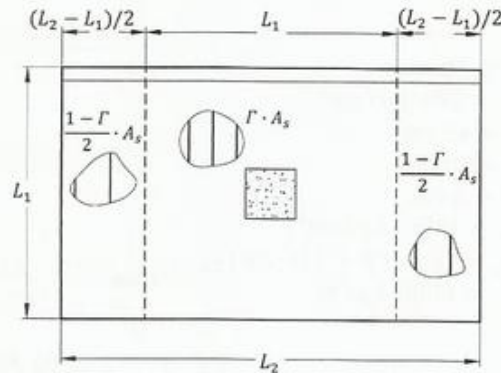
Distribución del refuerzo a flexión en zapatas rectangulares
